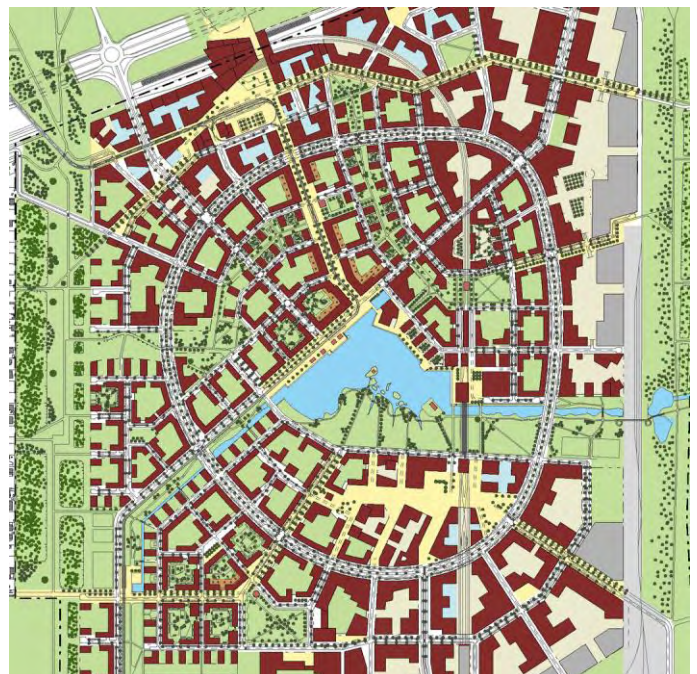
Ausschnitt Masterplan (Tovatt Architects & Planners AB)
